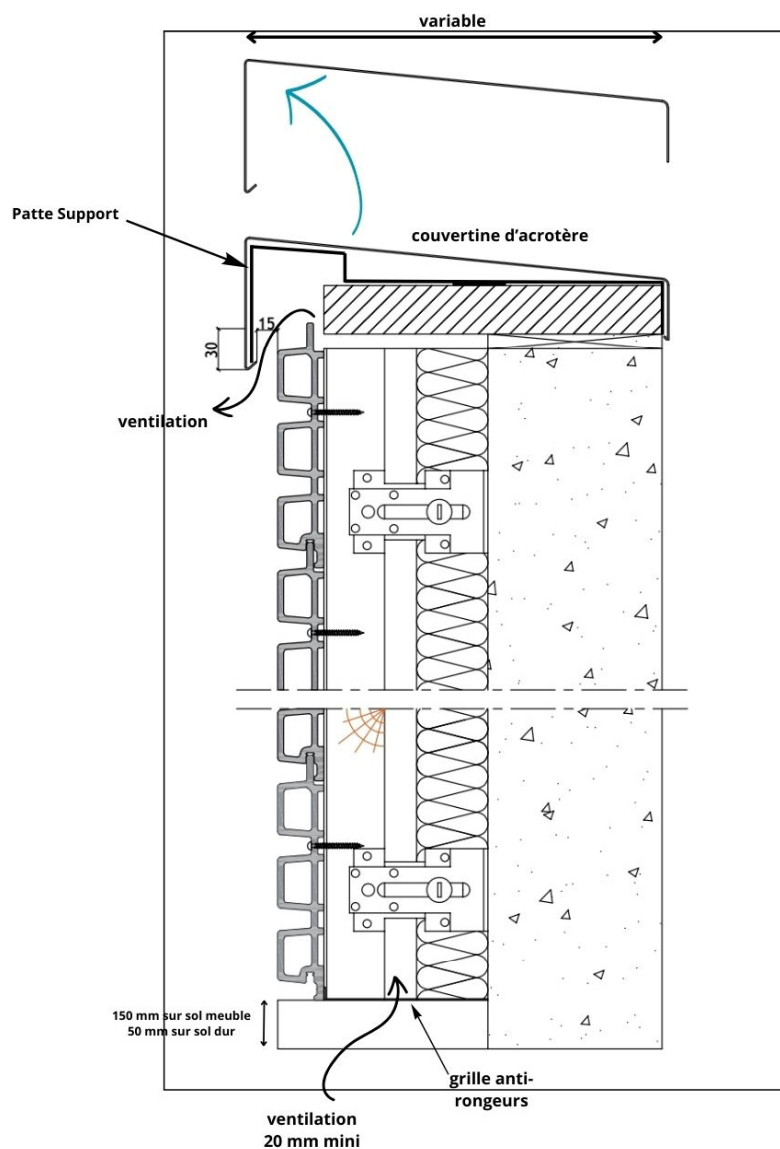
Départ et arrêt haut bardage sur OM en pose verticale - Coupe verticale
